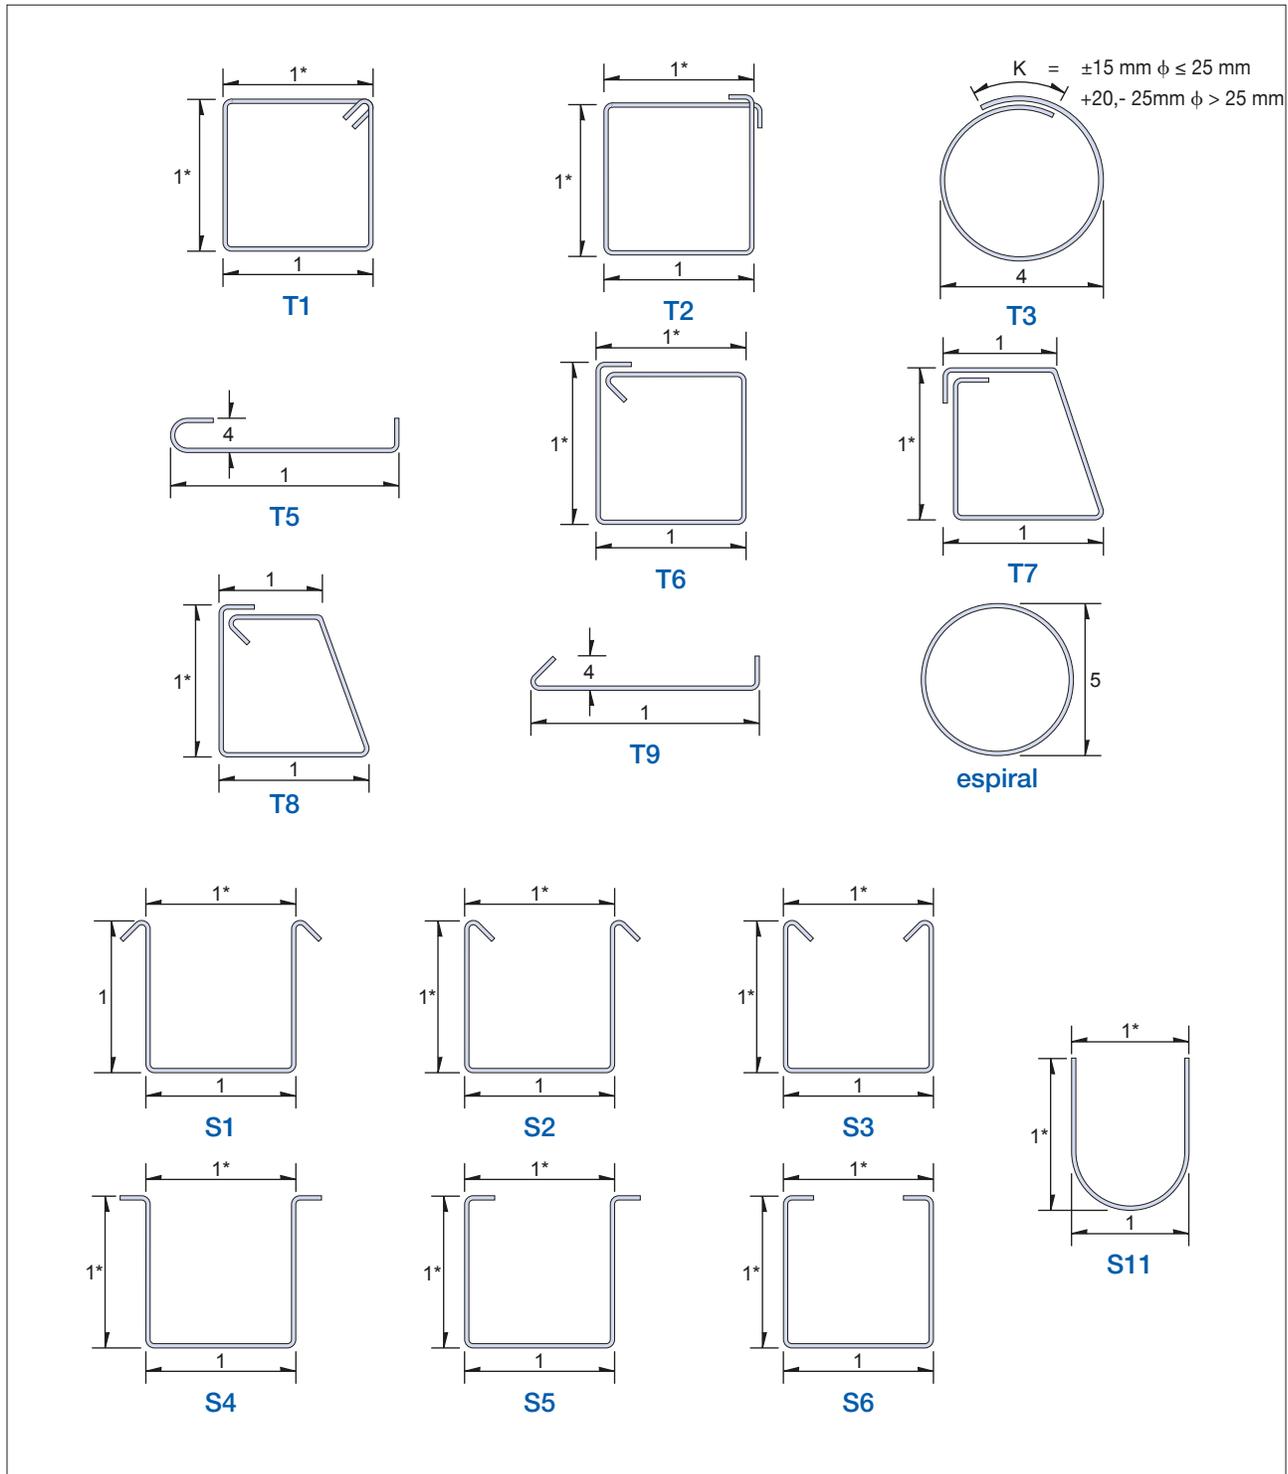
Tolerancias Estándar de Fabricación Estribos con barras de 8 a 36 mm (NCh211.Of2012)
